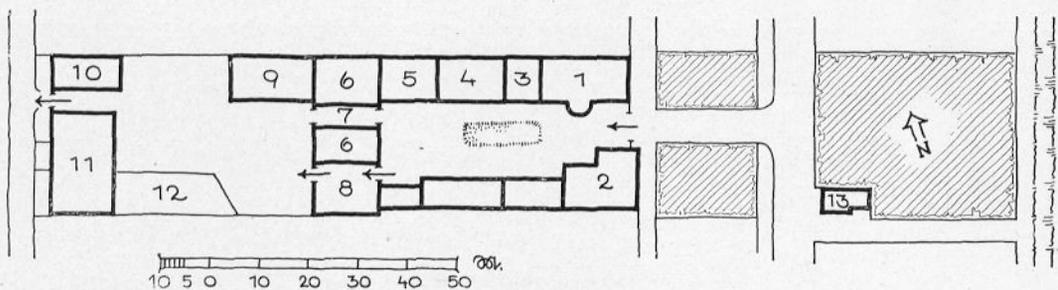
Typischer Grundriß eines Bauernhofes zu Piltzsch:
